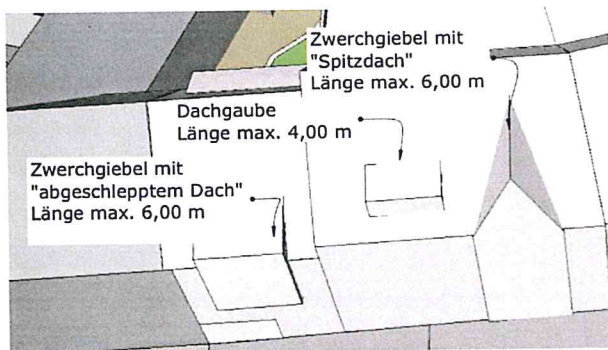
„Dachgauben und Zwerchgiebel - Wiesbadener Straße“
